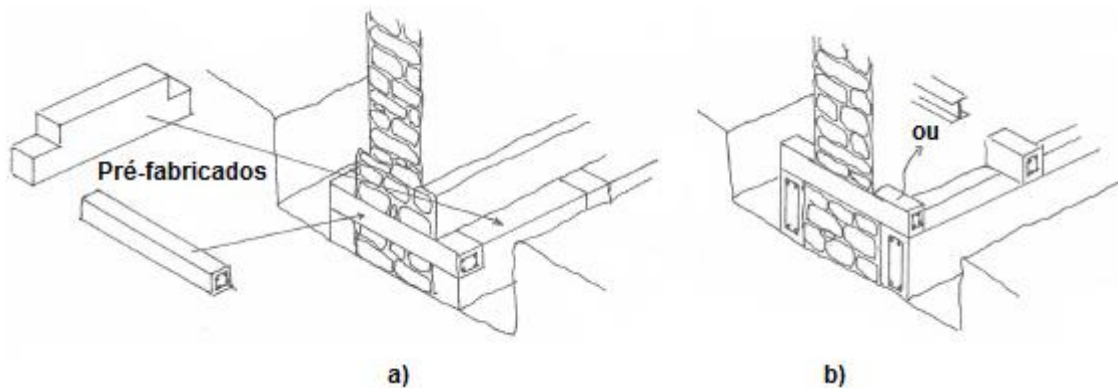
Alargamento conjugado com reforço da fundação: a) atravessando a própria fundação; b) atravessando a parede assente na fundação [55]
